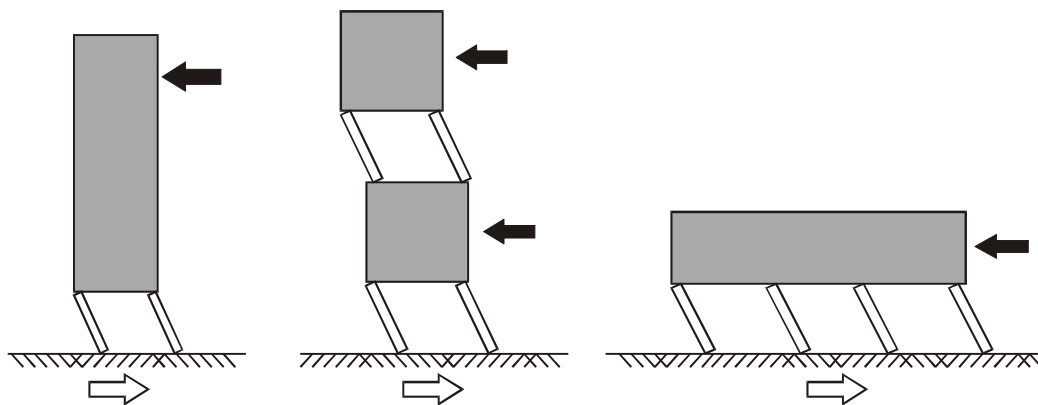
Bâtiments avec niveaux transparents. Lorsque les niveaux transparents sont plus flexibles que les autres niveaux, les colonnes de ces niveaux subissent de grandes déformations qui peuvent provoquer la ruine du bâtiment (soft floor), (AFPS, 2002)
